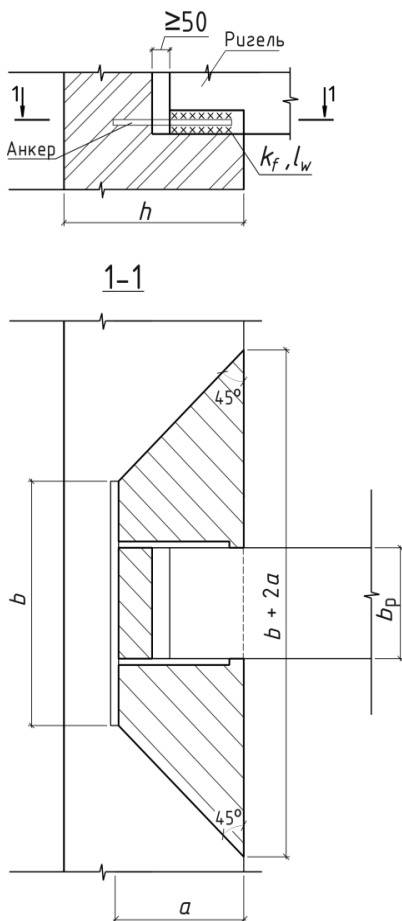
Анкеровка стены к ригелю перекрытия
